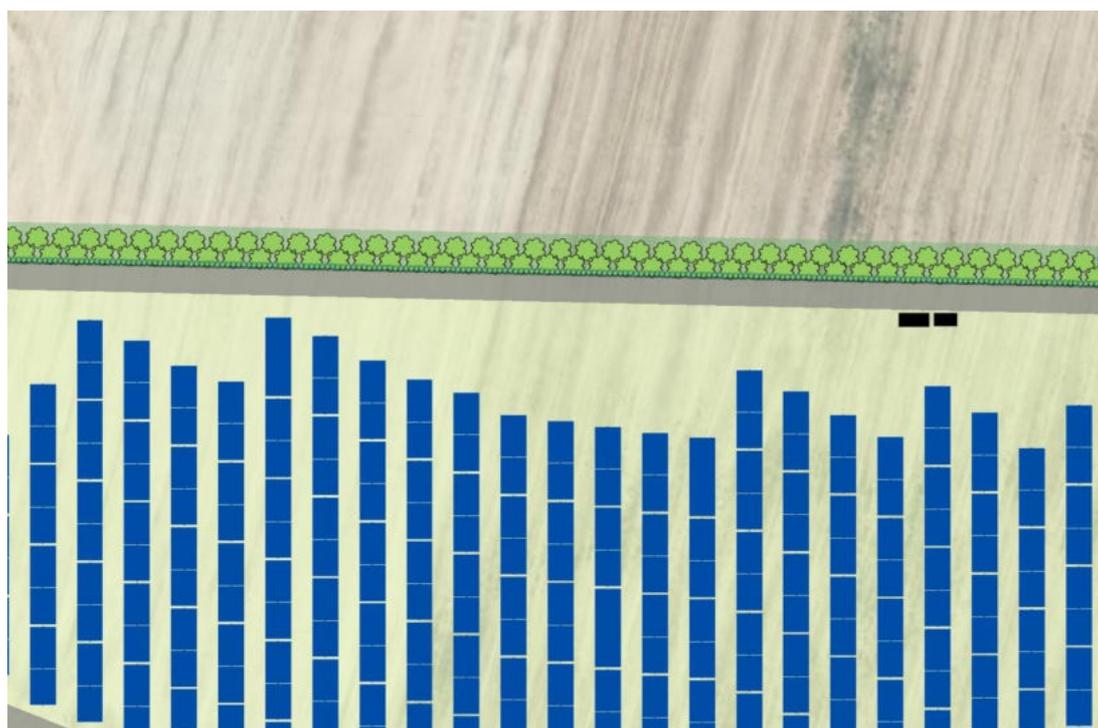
Particolare della fascia di mascheramento siepe e unico filare di olivo.
